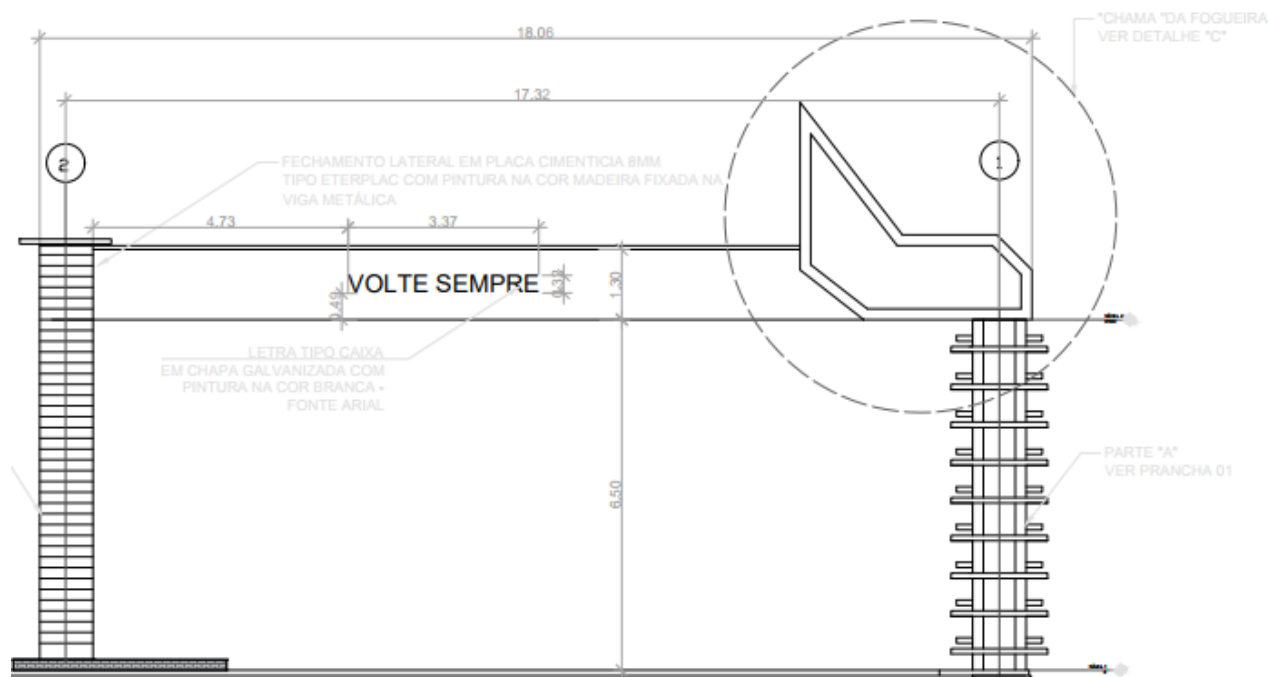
Fonte: Projeto Executivo da Contratada – Situação Proposta para o Pórtico
